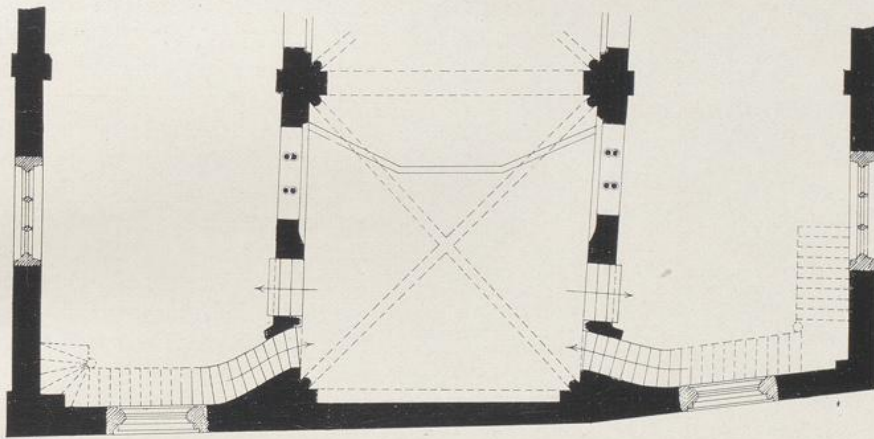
St.-Maria-Lyskirchen. Grundriss der Westempore.
